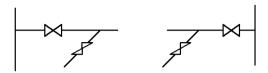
Размещение арматуры на ветвях в горизонтальных системах отопления
